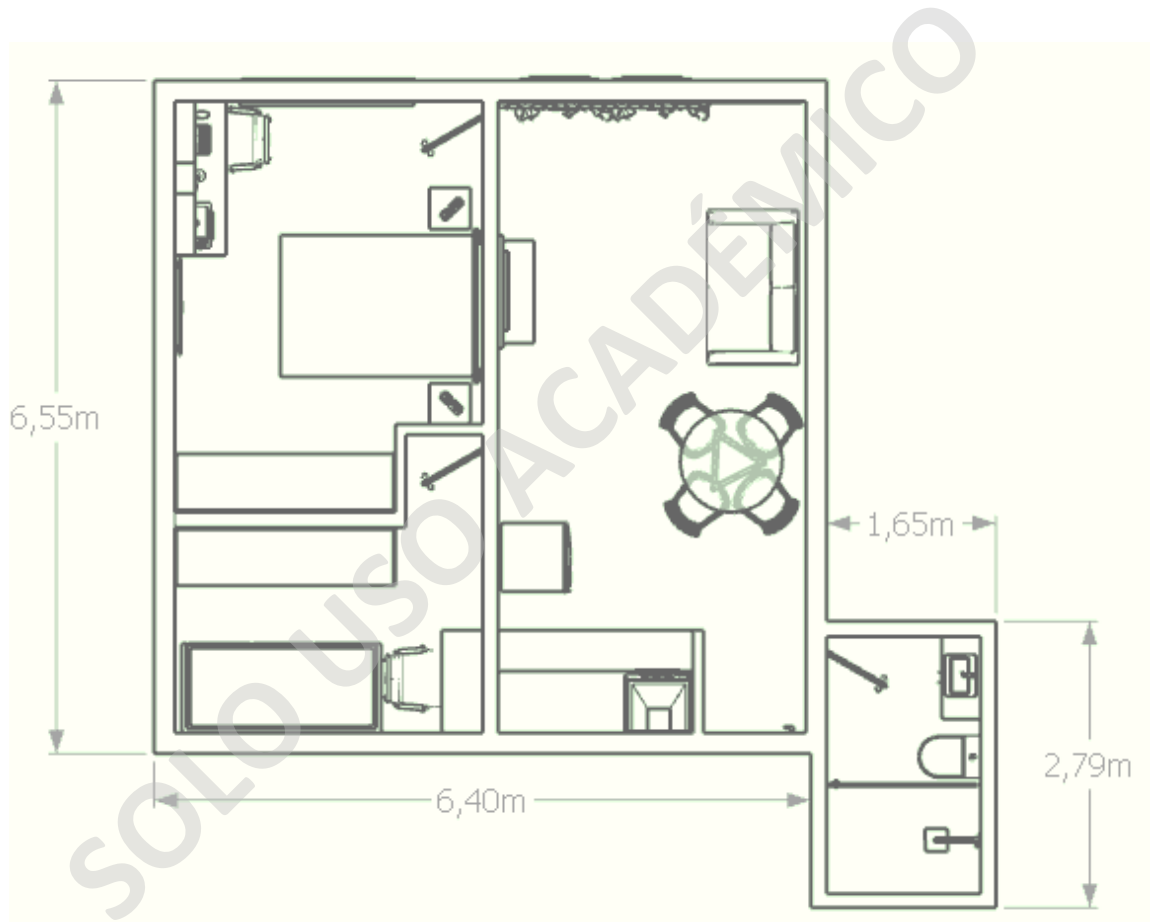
Planta Vivienda tipo de Hormigón armado, para caso supuesto. Fuente.
